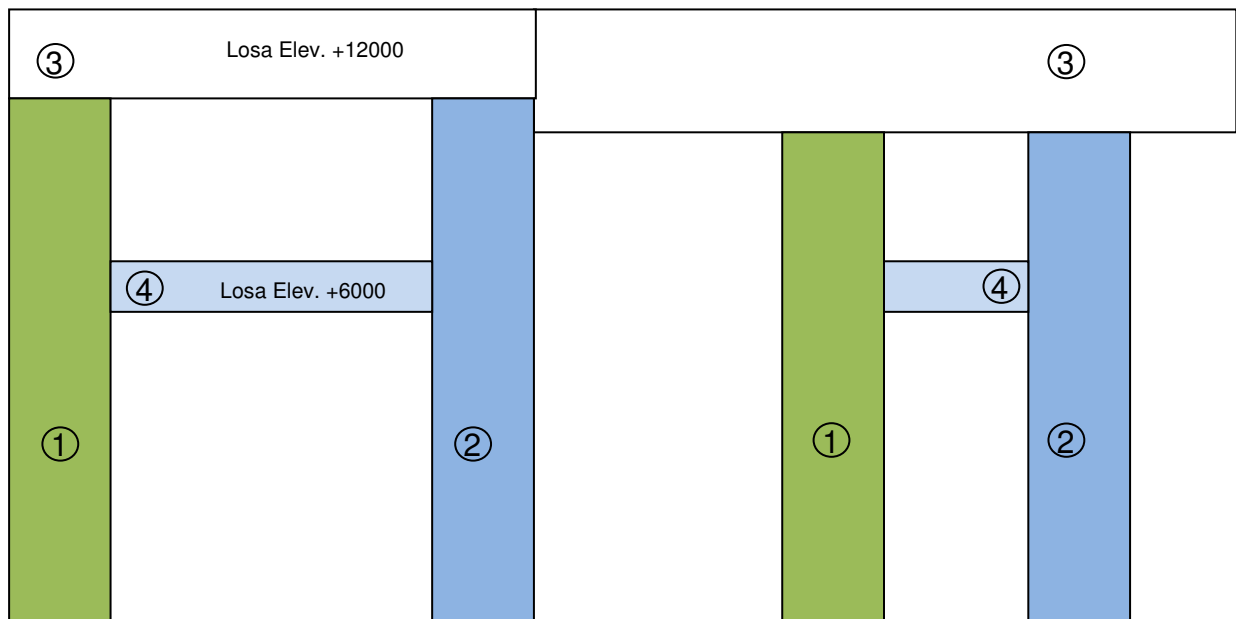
Secuencia constructiva propuesta con la utilización de conectores espigados (cortes transversales)
